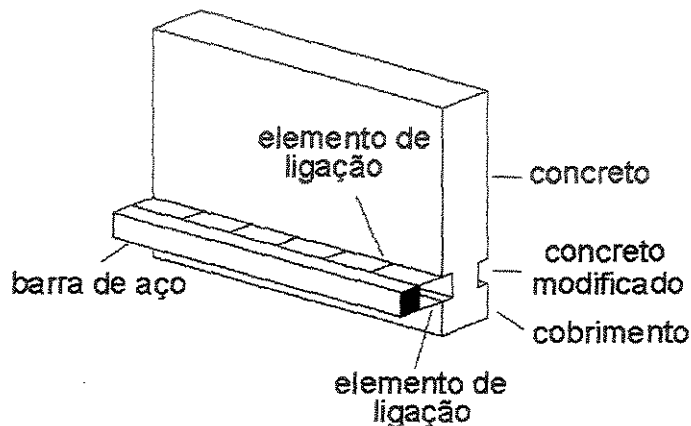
Elemento de ligação: topo e base das barras de aço.
